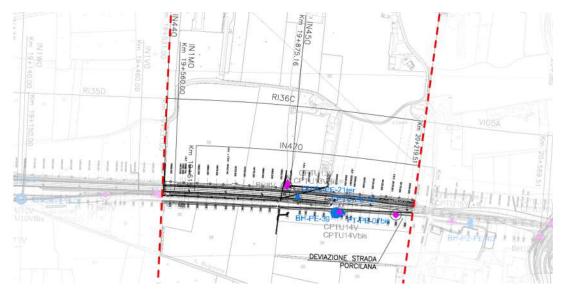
Planimetria Rilevato RI36C, estratto dalla Planimetria Generale (Doc. Rif. [7])
